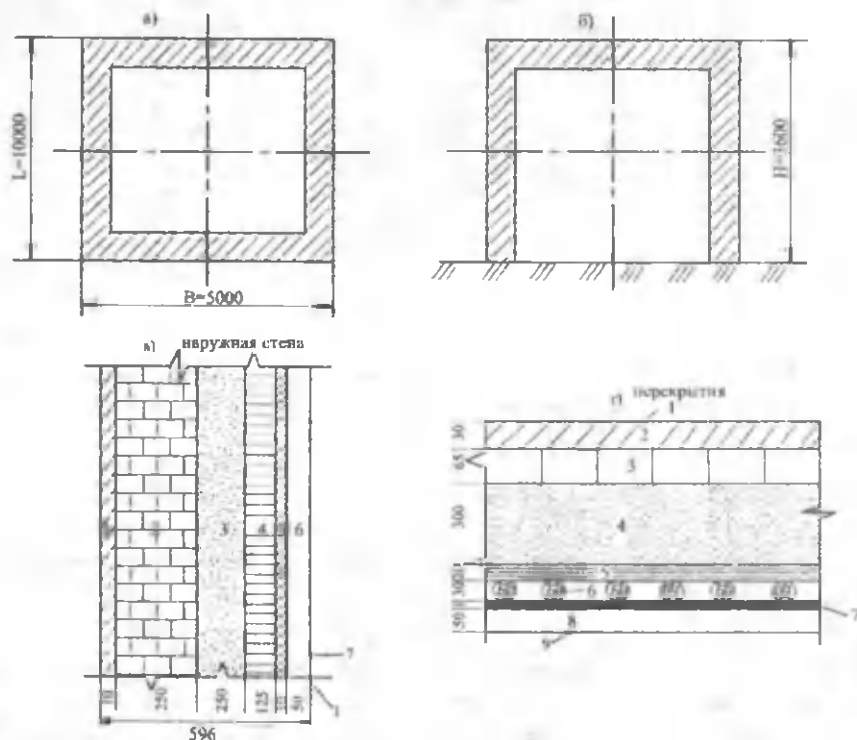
Конструктивная схема надземного плодовоовощехранилища: а) план; б) поперечный разрез; в) поперечное сечение наружной стены: 1 – штукатурка; 2 – кирпич; 3 – опилки (теплоизоляция); 4 – глиняный кирпич; 5 – штукатурка; 6 – воздушная прослойка; 7 – металлическая фольга; г) поперечное сечение перекрытия: 1 – кровля (исбоцемент); 2 – глиняно-соломенная затирка; 3 – глиняный кирпич; 4 – опилки (теплоизоляция); 5 – камыш; 6 – деревянные доски; 7 – металлический лист; 8 – воздушная прослойка; 9 – полиэтилен ПВД
